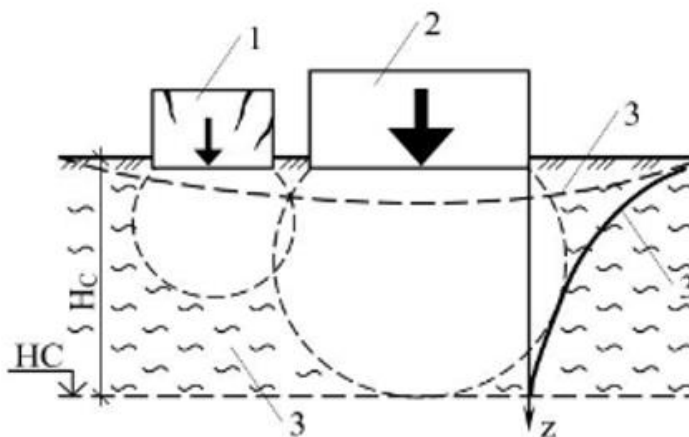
Осідання поверхні ґрунту: 1 – існуюча будівля; 2 – будівля, що зводиться; 3 – вирва осідання
